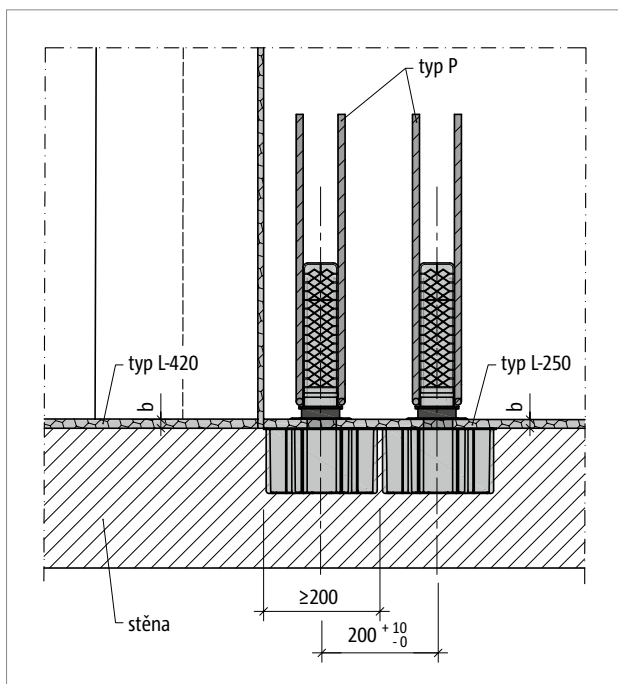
Schöck Tronsole® typ P: Uspořádání prvků, detail B
